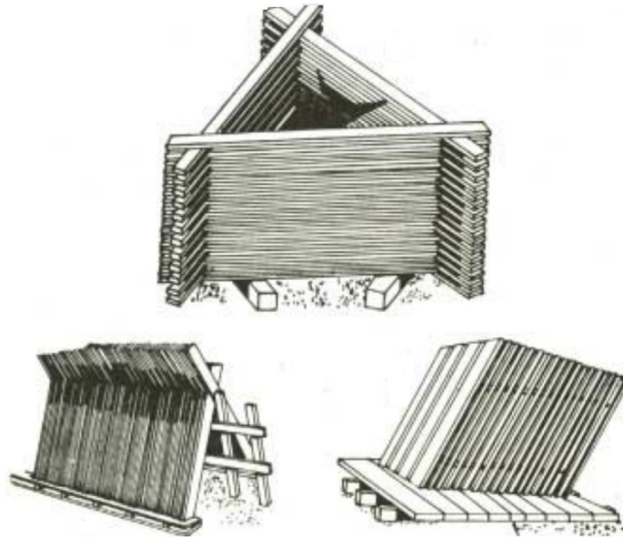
Tipos de pilhas para secagem da madeira ao ar [30]
